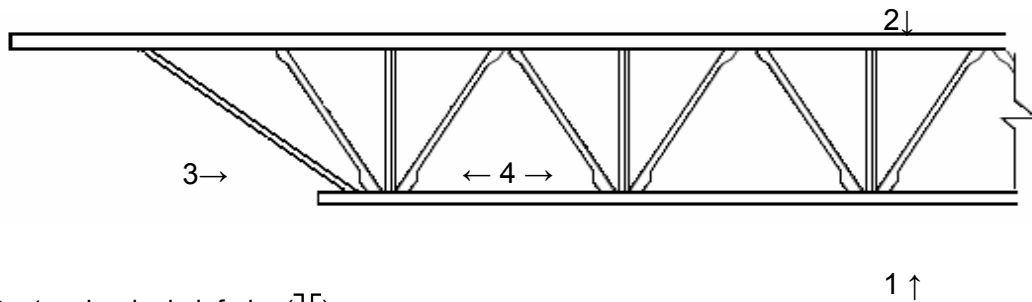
Esquema do dimensionamento das vigas treliçadas (joists) 30K8, [56]
